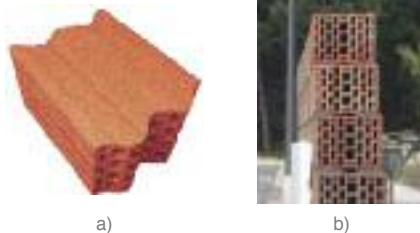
Blocos cerâmicos de furação horizontal: a) tijolo; b) aplicação na construção de uma parede.
